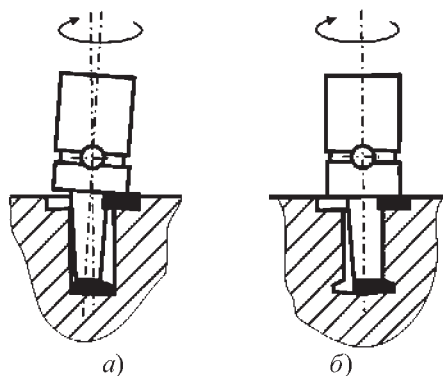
Схема формирования глухих крепежных отверстий в фасадных плитах:
